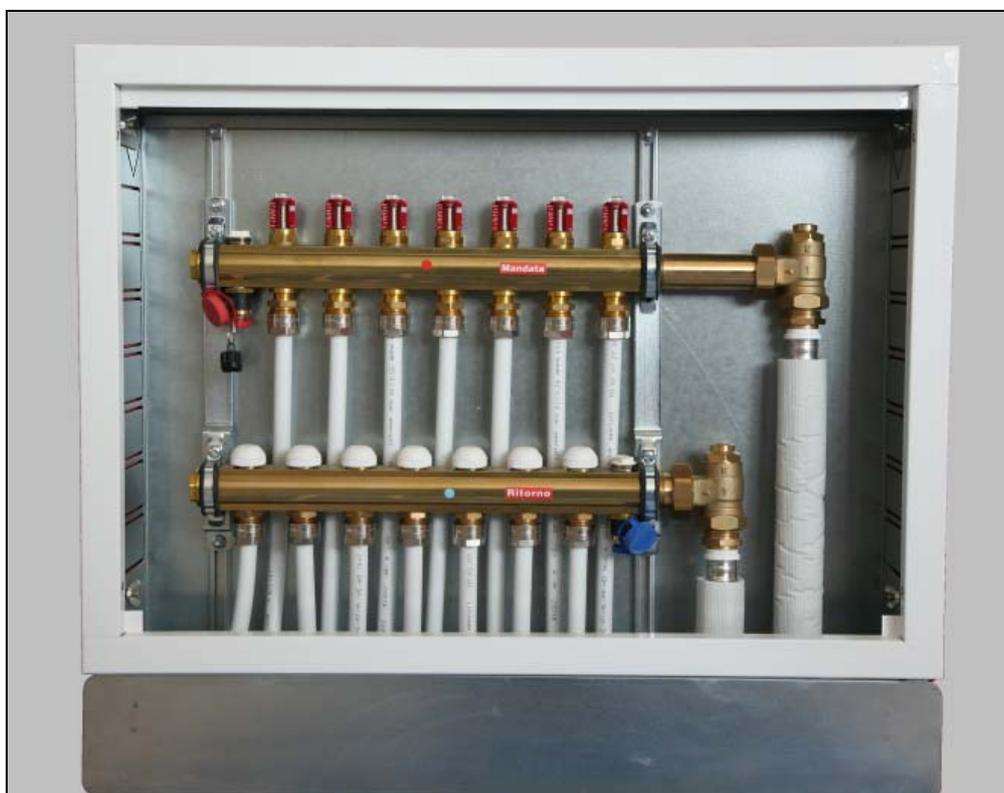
Cassetta da incasso con set collettori in barra per impianto a pavimento radiante
